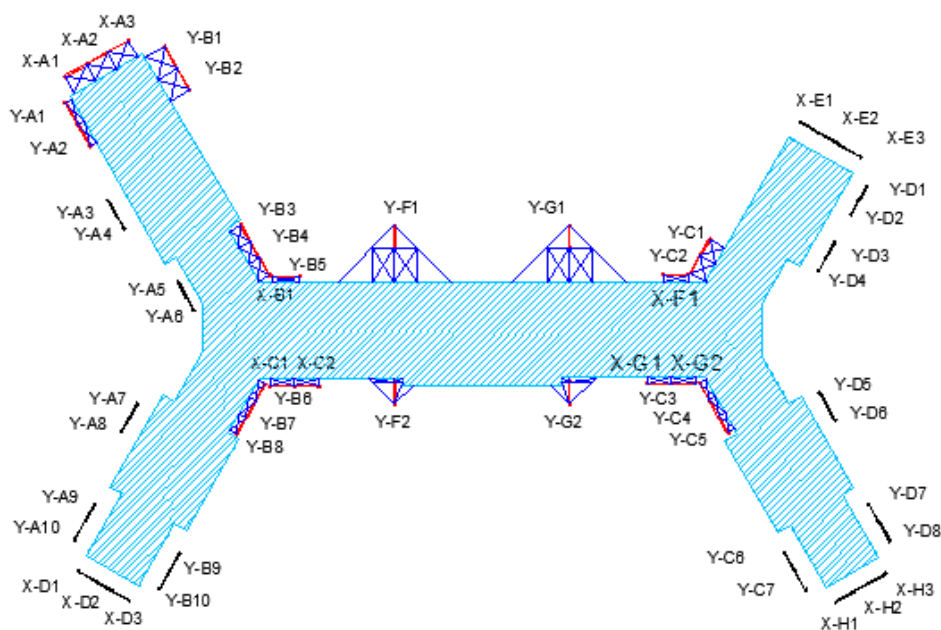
Schema in pianta del nuovo sistema sismo-resistente in acciaio.
